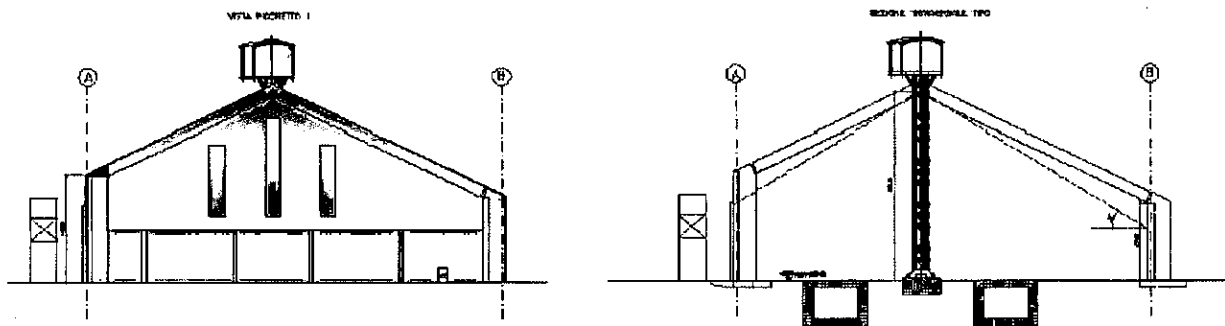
b Prospetto e sezione della copertura parco Nord
